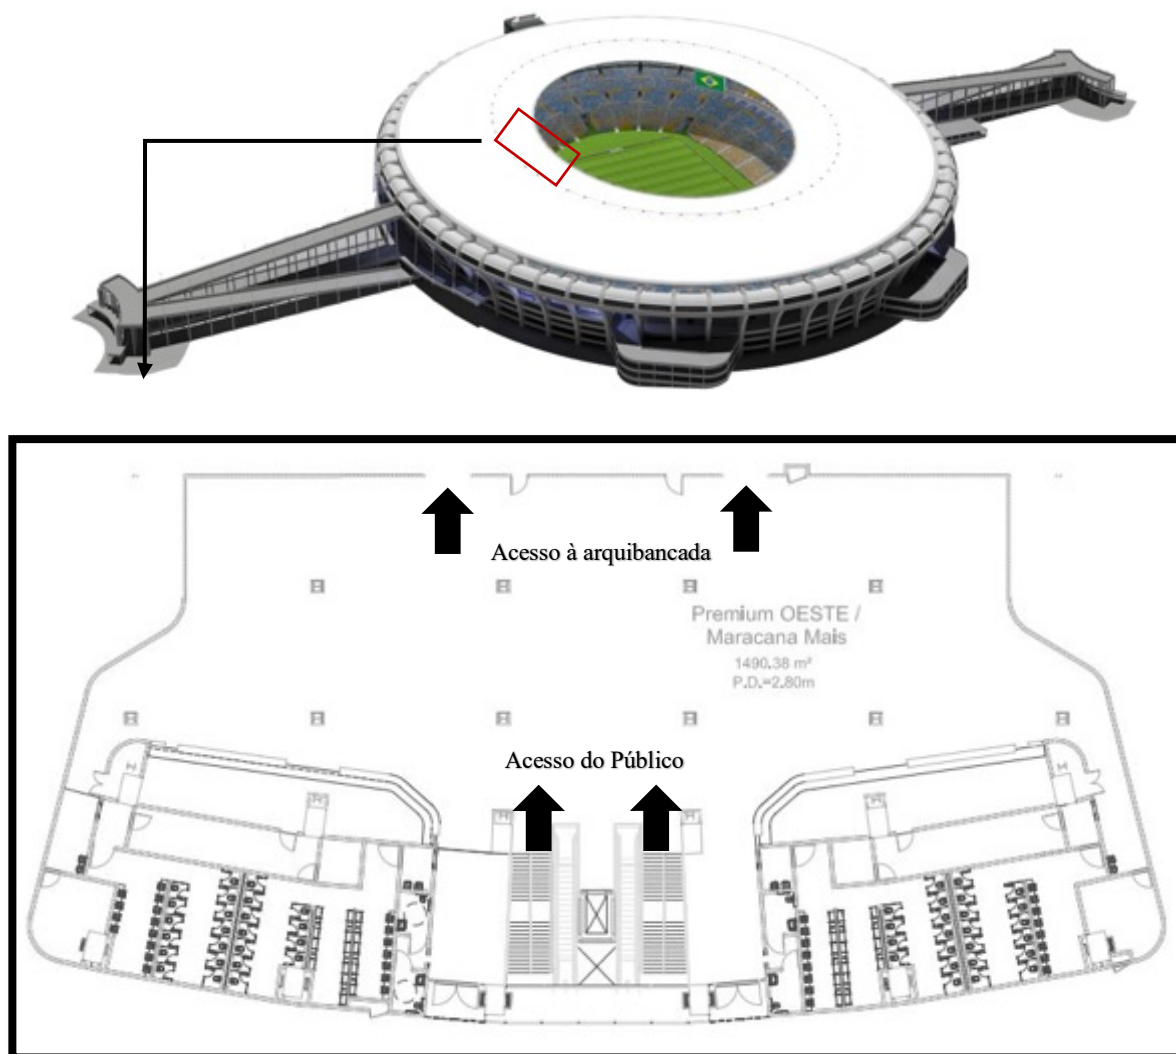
Lounge VIP – 1º Pavimento Oeste – “MARACANÃ MAIS”
